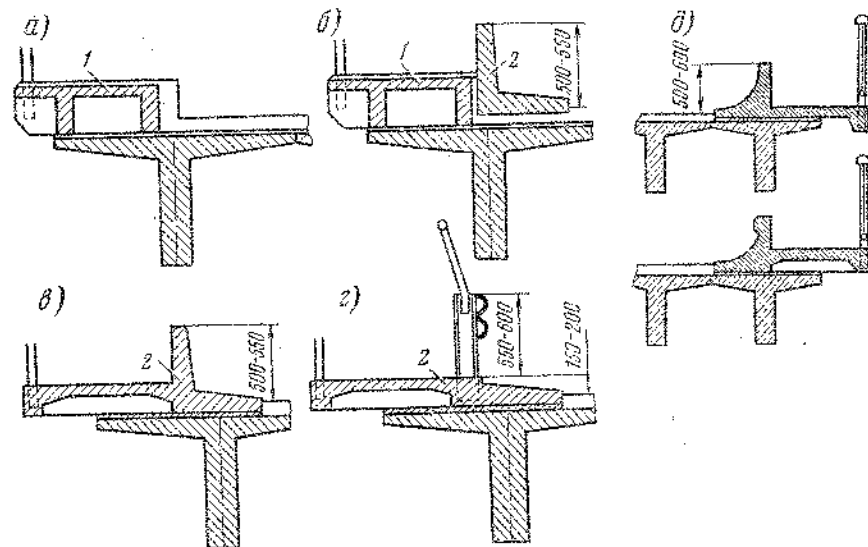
Конструкции ограждений на сборных железобетонных мостах: 1 — тротуарный блок; 2 — тротуарный блок, совмещенный с бордюром
